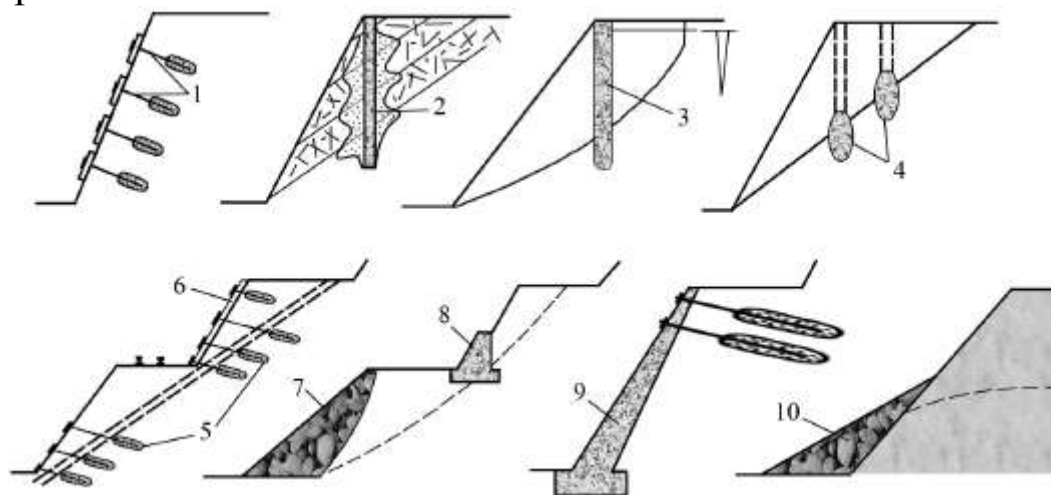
Механические способы укрепления карьерных уступов: 1 – анкерами; 2 – железобетонными сваями с цементацией пород вокруг свай; 3 – сваями большого диаметра, работающими на изгиб; 4 – железобетонными шпонами; 5 – анкерными тяжами (штангами); 6 – железобетонными плитами (наборными стенками); 7 – контрфорсом, 8 – подпорной гравитационной стенкой; 9 – подпорно-защитной заанкерванной стенкой; 10 – пригрузкой из фильтрующего материала (контрбанкет)
